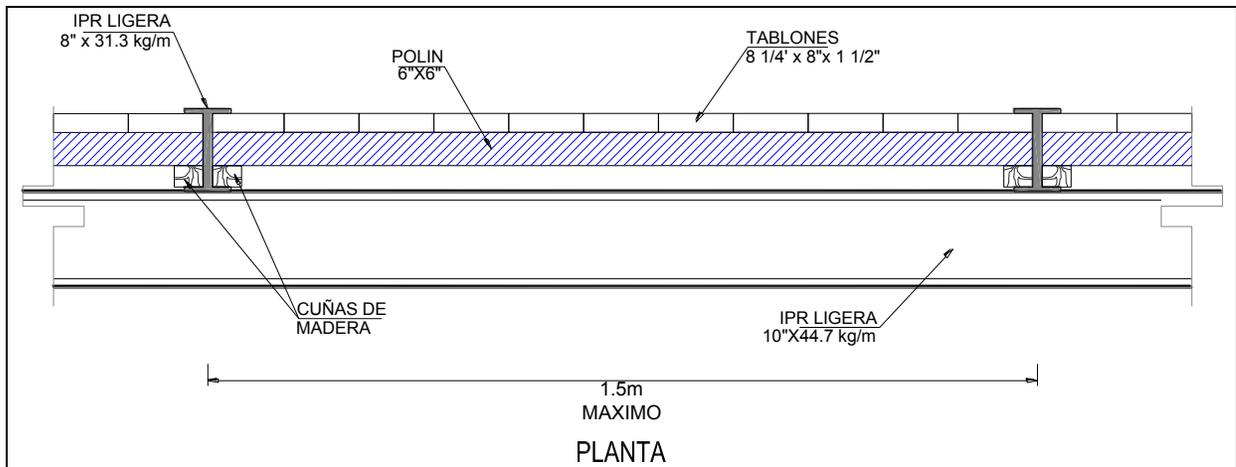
Planta del sistema de contención de la excavación. Fuente: Especificaciones RIOBOO S.A.
